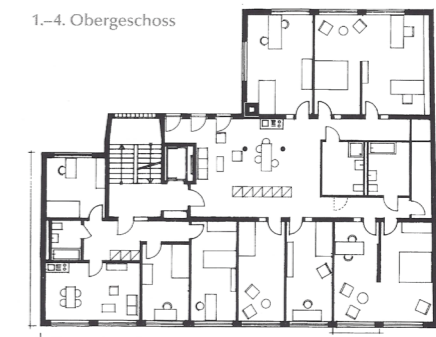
Karthago Grundriss 1.-4. OG
